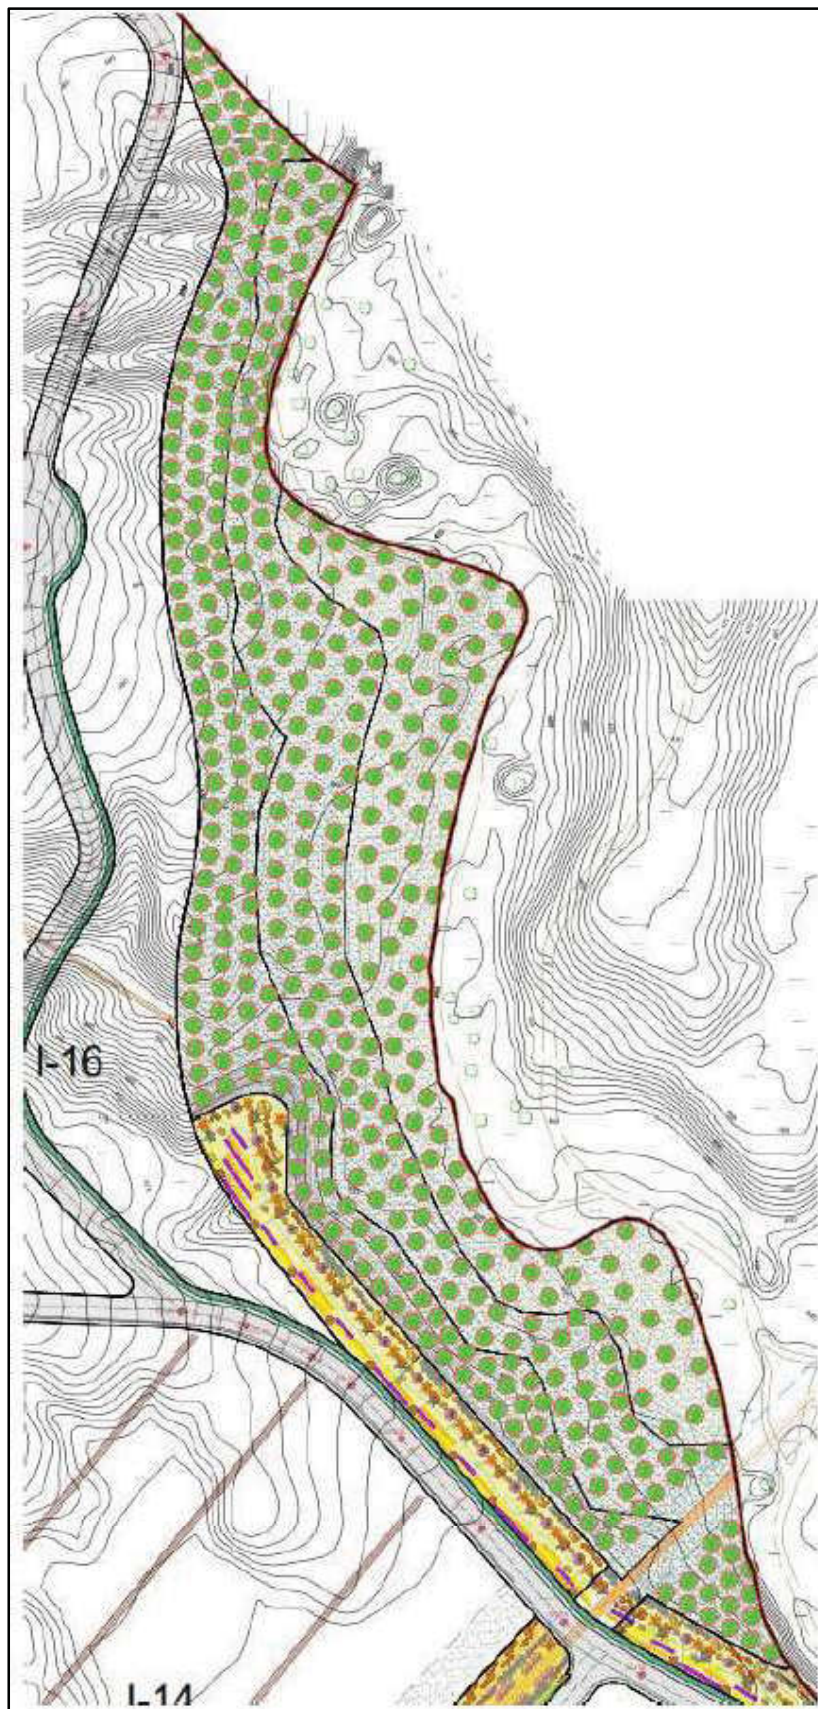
Proyecto en el ámbito de la DC-02 REFORESTACIÓN.
